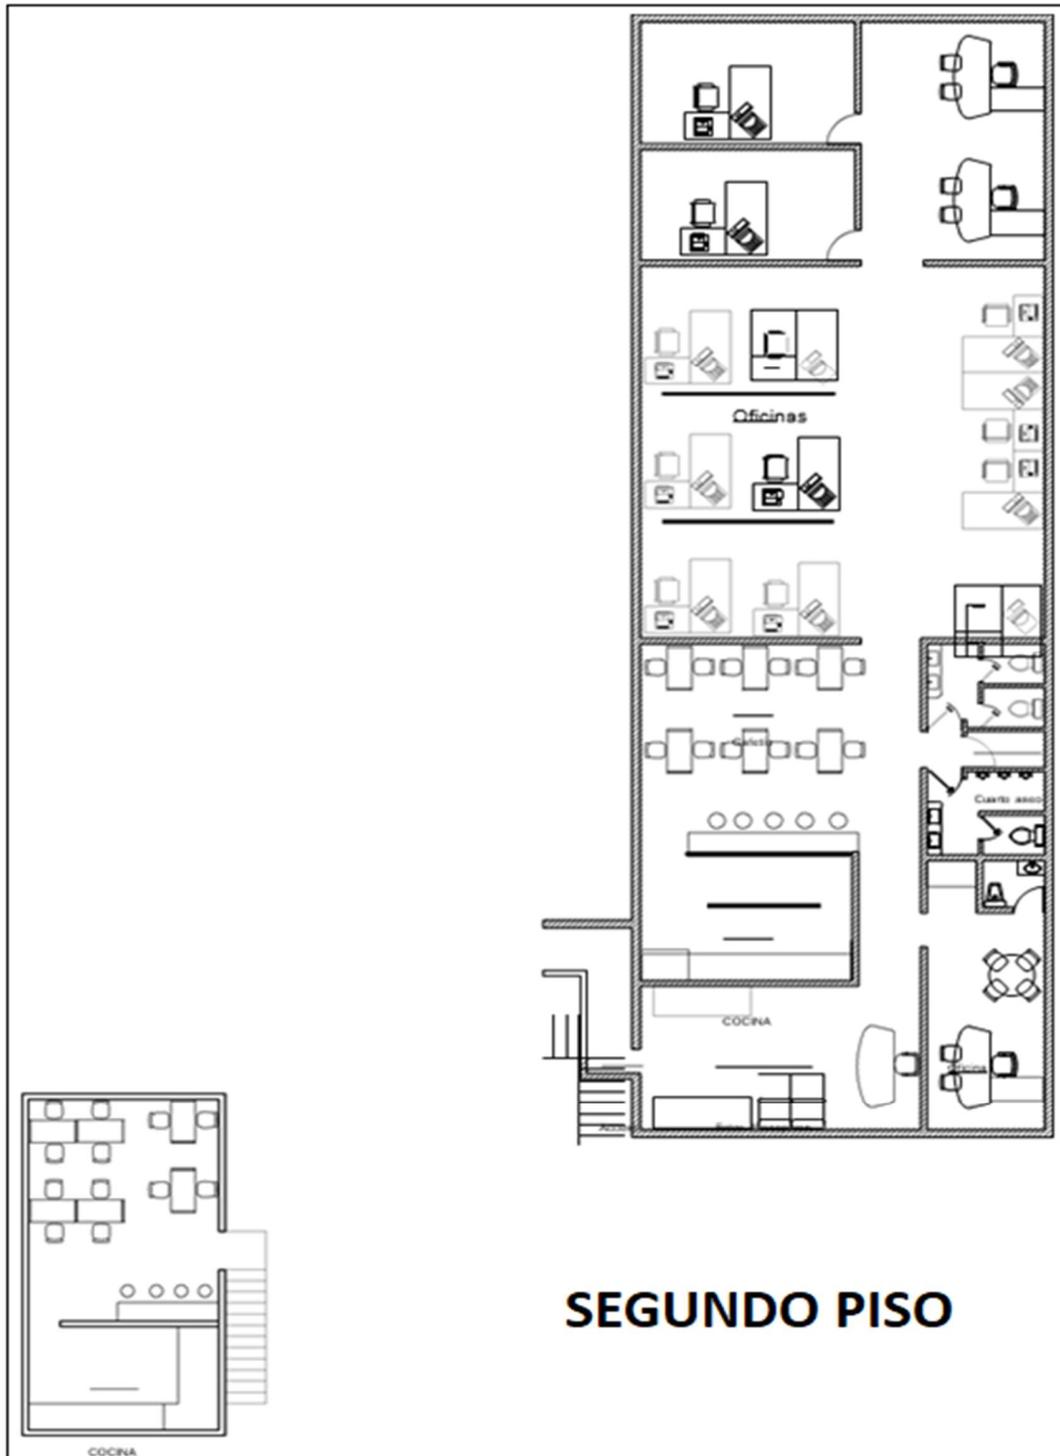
Plano del nuevo diseño en Autocad Planta segundo piso.
